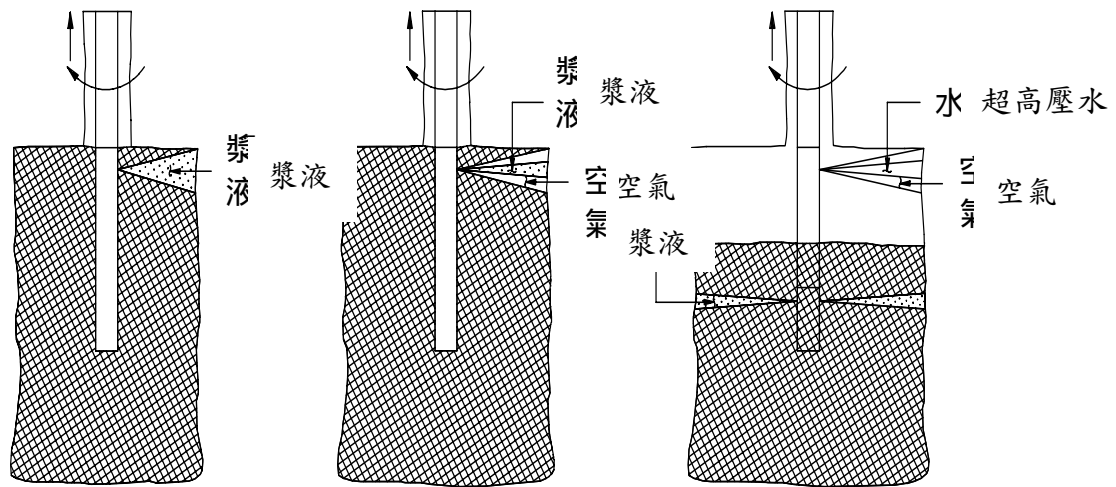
高壓噴射攪拌灌漿工法施工順序示意圖
